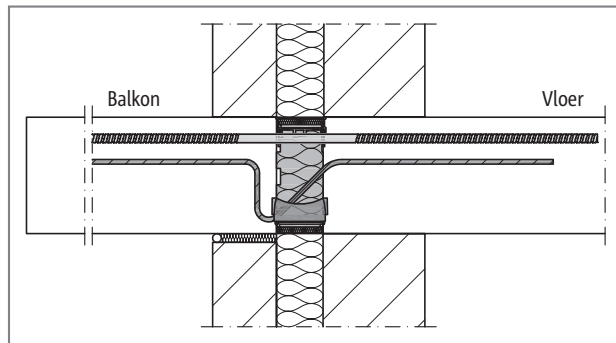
Schöck Isokorb® CT type K-T, T type Q-E-VV: balkon aan binnenhoek, dubbelzijdig
